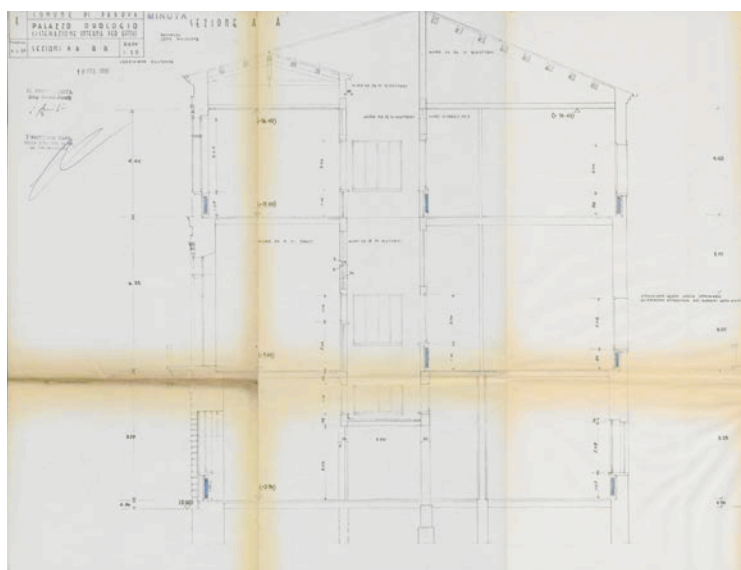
Estratto sezione A-A (1960) - (Archivio del Comune di Padova)
